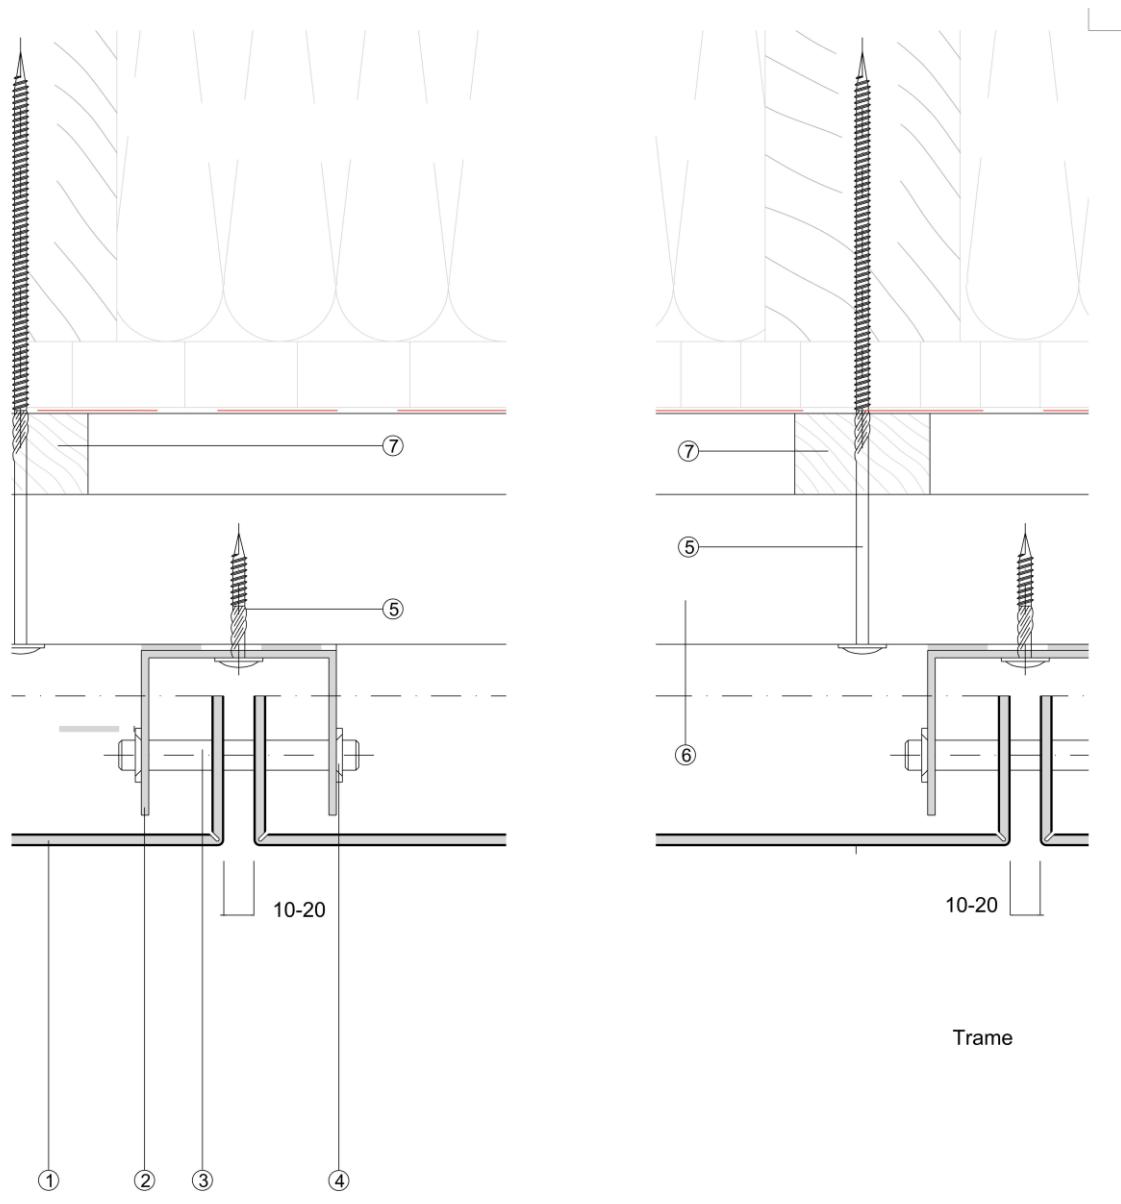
Joint horizontal entre panneaux avec point fixe de cassette pour un système d'ossature en U (Elévation)
